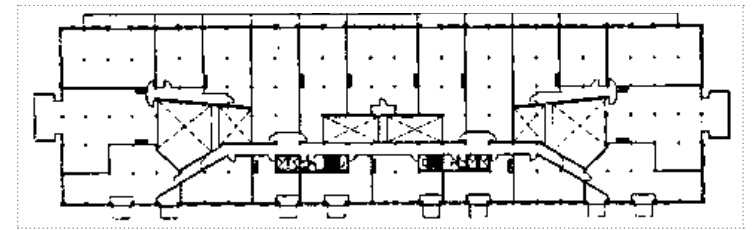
Planta 2º e 3º pavimento do Galpão 5, onde se distribuem as unidades habitacionais. Fonte: Revista Arquis nº 1.
